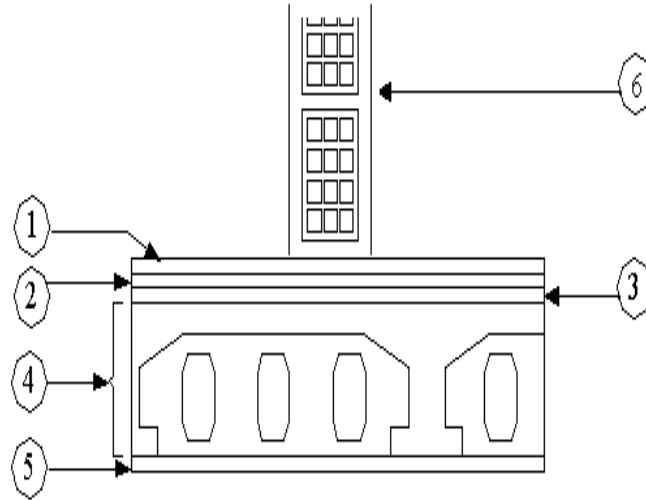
Coupe du plancher étage courant (corps creux).
